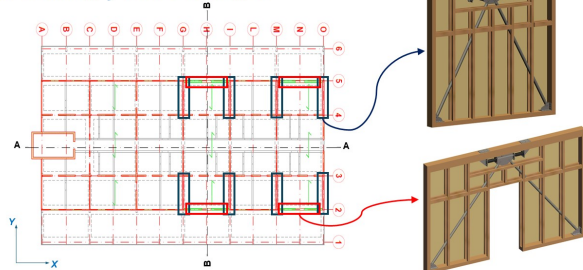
Pianta e viste 3D della sopraelevazione LFT con controventi dissipativi
